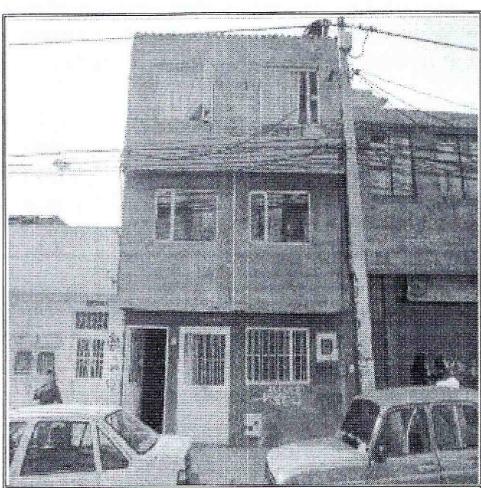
Vista frontal del predio de la Carrera 100 A No. 140 B - 49 Barrio Java II Sector Localidad de Suba
